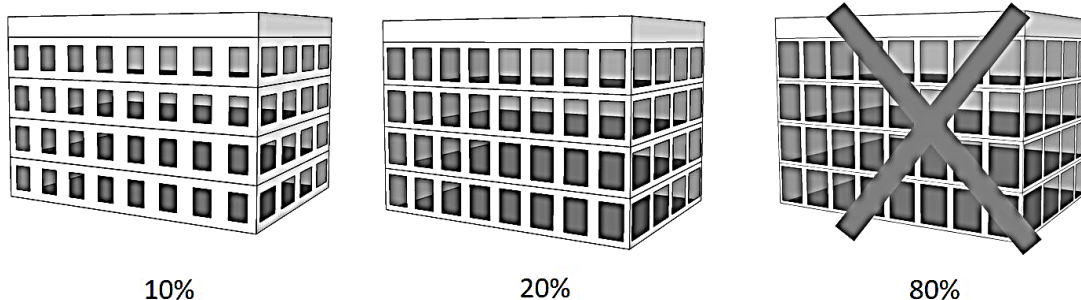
Exemplos de fachadas e respectivas proporções de fachada envidraçada.
